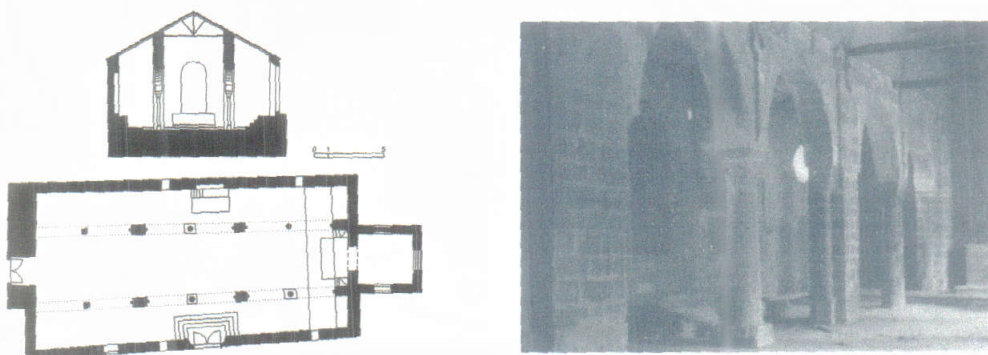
Planta, sección transversal e interior de la iglesia antes de la restauración.
